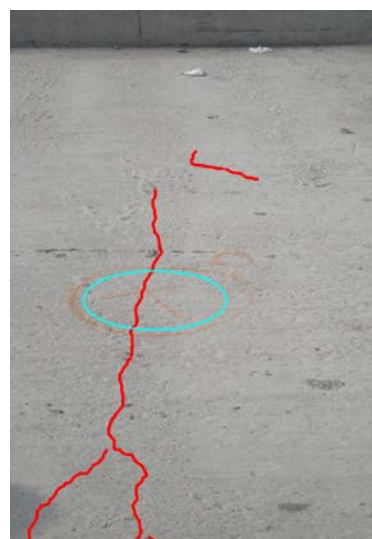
B Detalle Selección de Fisuras para Muestra, Sector General Arriagada, Calzada Poniente. Línea Roja Describe Trayectoria de Fisura en Superficie Acercamiento.
